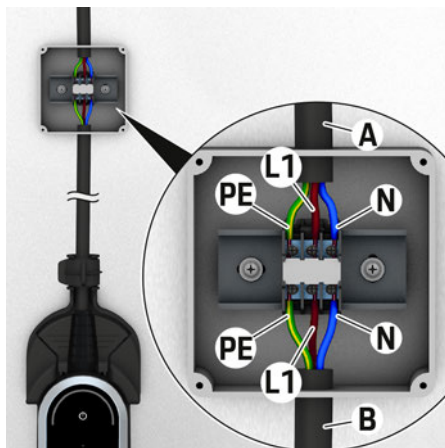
Forbindelser til boks til fast installation (en-faset)
